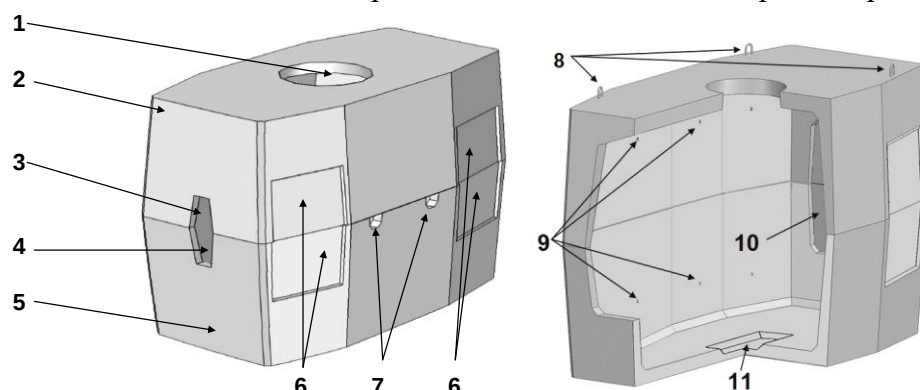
Колодец «ККСр-5-80», внешний вид и детали элементов колодца:
